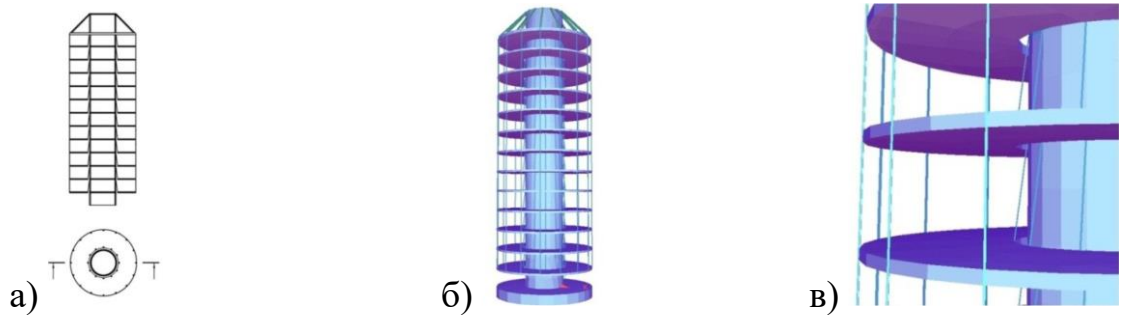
Схема здания с подвеской перекрытий к оголовку и стволу: а) поперечный разрез; б) расчётная схема; в) схема расположения подвесок
